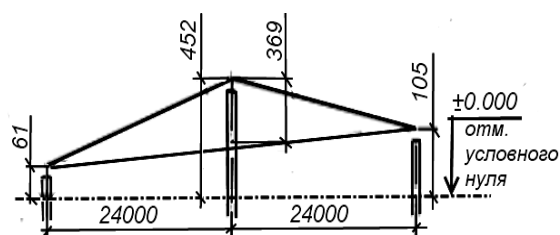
Схема нивелировки нижнего пояса одной из балок (с максимальными перепадами отметок) перед испытанием
